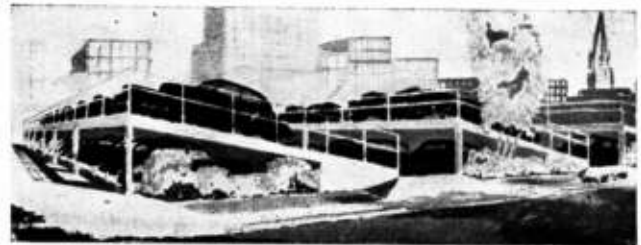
Ejemplo de instalación del Sistema Para-Park en un lote horizontal, que ha sido nivelado en forma de dientes de sierra con los terraplenes colocados contra muros de contención. Para las cubiertas superiores se pueden utilizar losas de hormigón, madera o cualquier otro material similar. Un solo pasaje alcanza para servir los dos niveles de estacionamiento.
